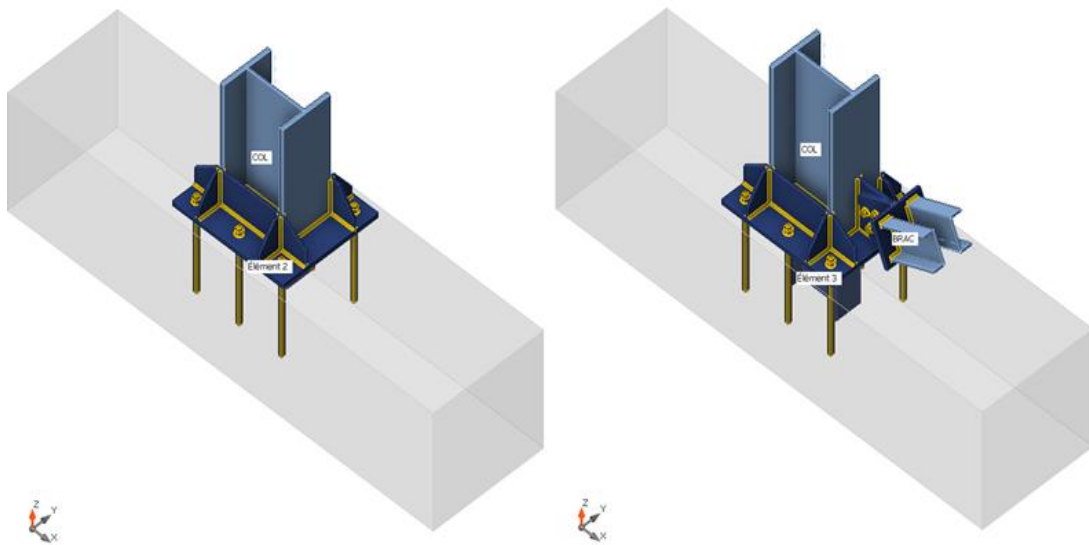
Vue 3D de l'assemblage pied de poteaux.
